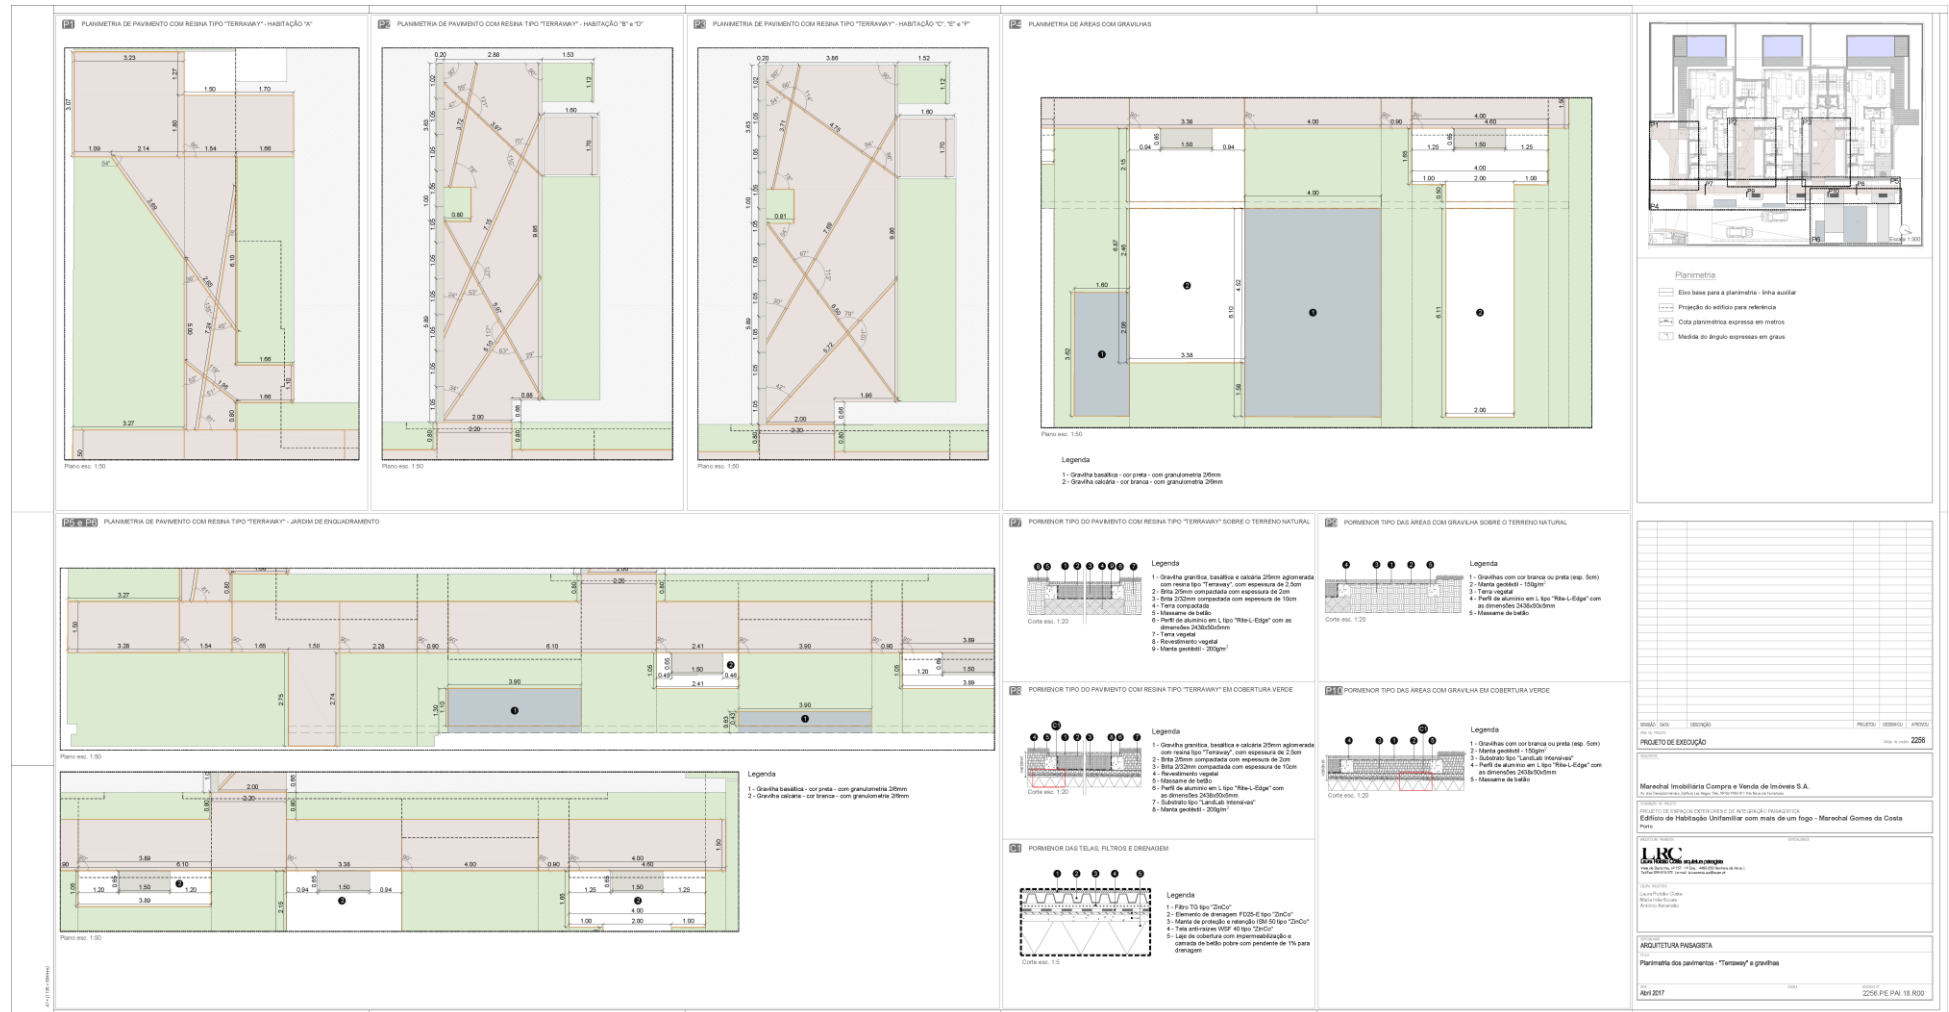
Planimetria dos pavimentos do Projeto Marechal 1000: “Terraway” e gravilhas.
